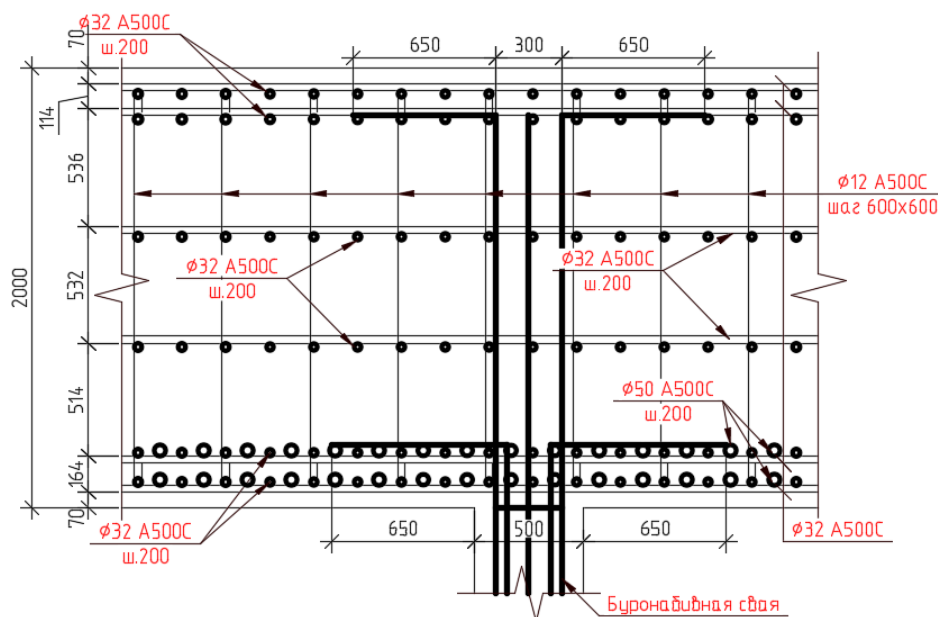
Конструкция монолитной железобетонной плиты
